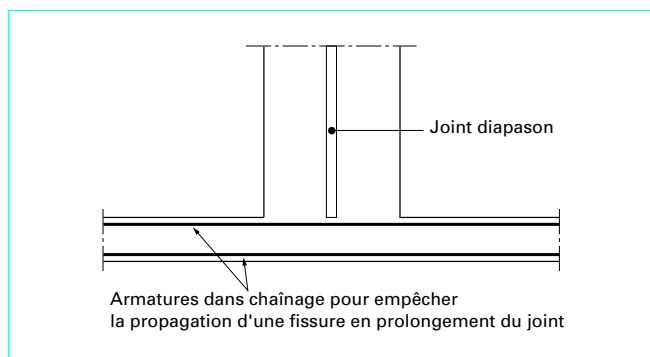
Joint diapason dans la hauteur de l'étage sous plancher-terrasse
